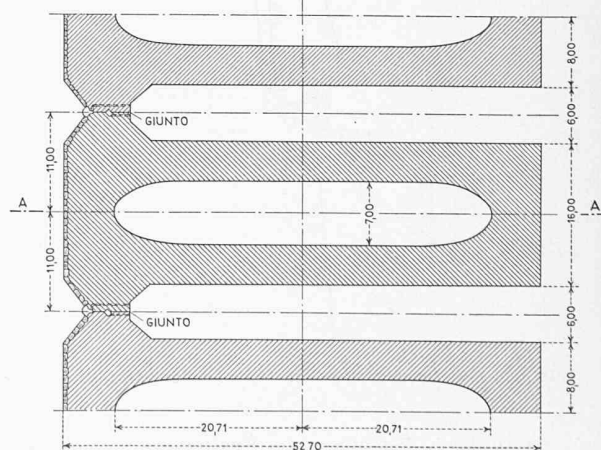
Zentrale Cividate, Grundriss 1:600
